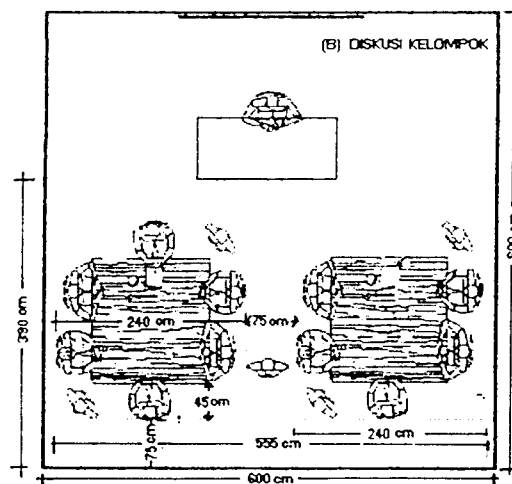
Lay Out Ruang Studio Lanjutan
